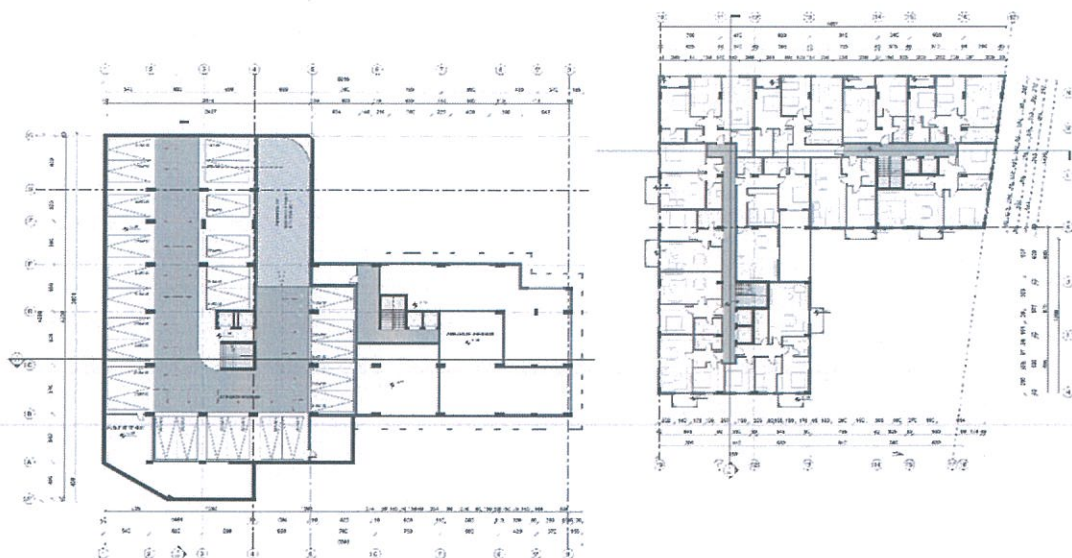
Plani I katit perdhe 2657.3 m² (parkim dhe banim)
